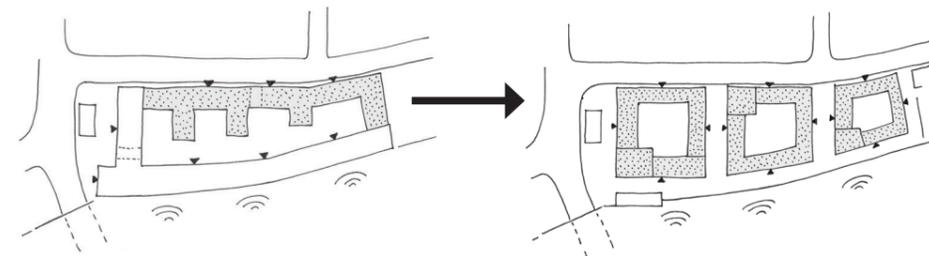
Schematischer Lageplan Vorher-Nachher (ohne Maßstab)
